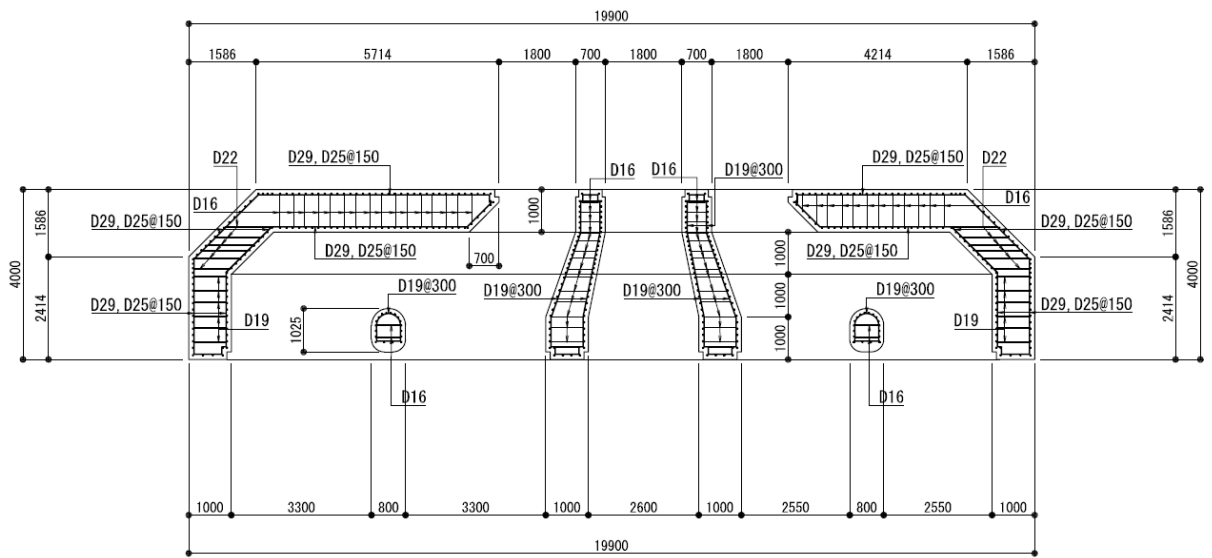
(3) 補機冷却用海水取水路の断面図 (北側, C-C断面)
